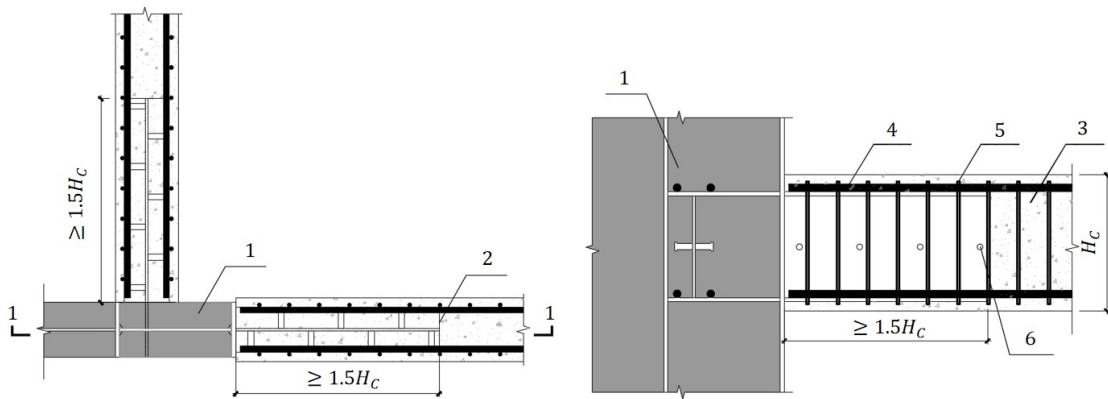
PEC剪力墙与钢筋混凝土梁连接示意
